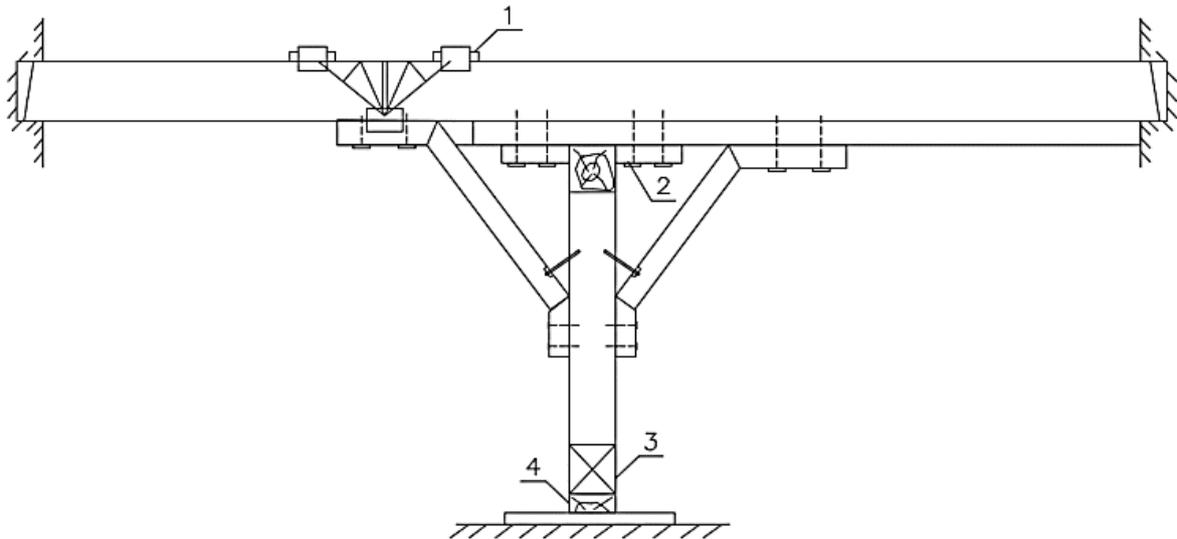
Вывешивание дефектной балки: 1 – ригель; 2 – скрутка или хомут; 3 – подтяжка
